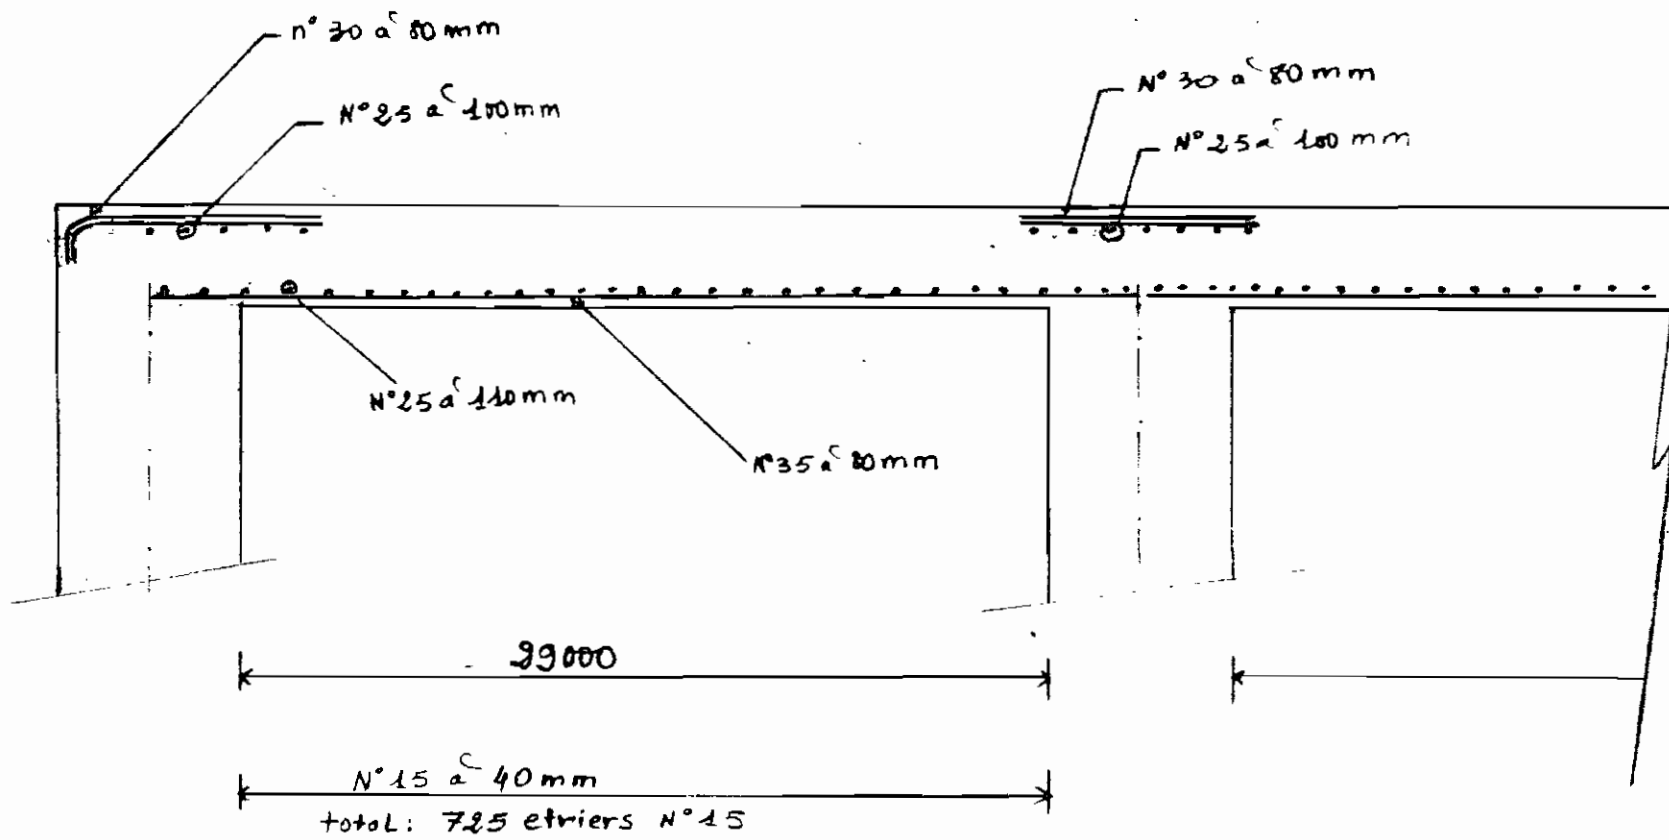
b: Schéma de ferrailage de la dalle d'une travée de rive.
